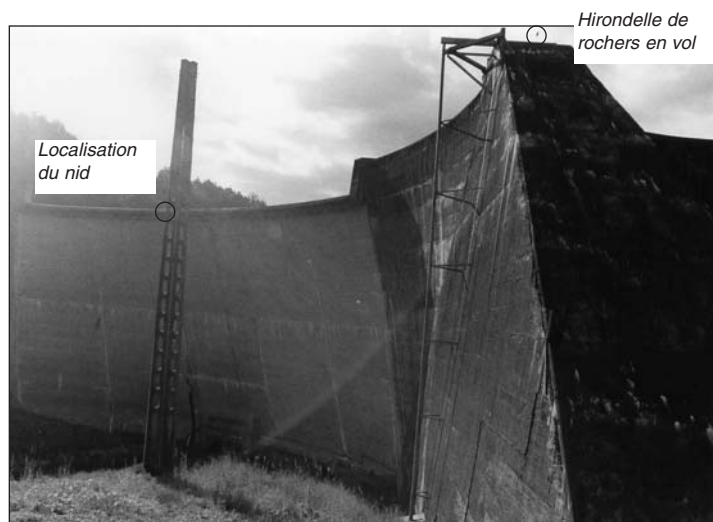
Barrage du Mont-Larron (septembre 2004) – Le nid est construit au centre du barrage, à 28 m du sol, sous la corniche. Les oiseaux se reposaient, en se réchauffant au soleil, soit sur la structure métallique à droite, soit sur un parapet de béton en biseau, sur la droite, derrière la structure métallique.
